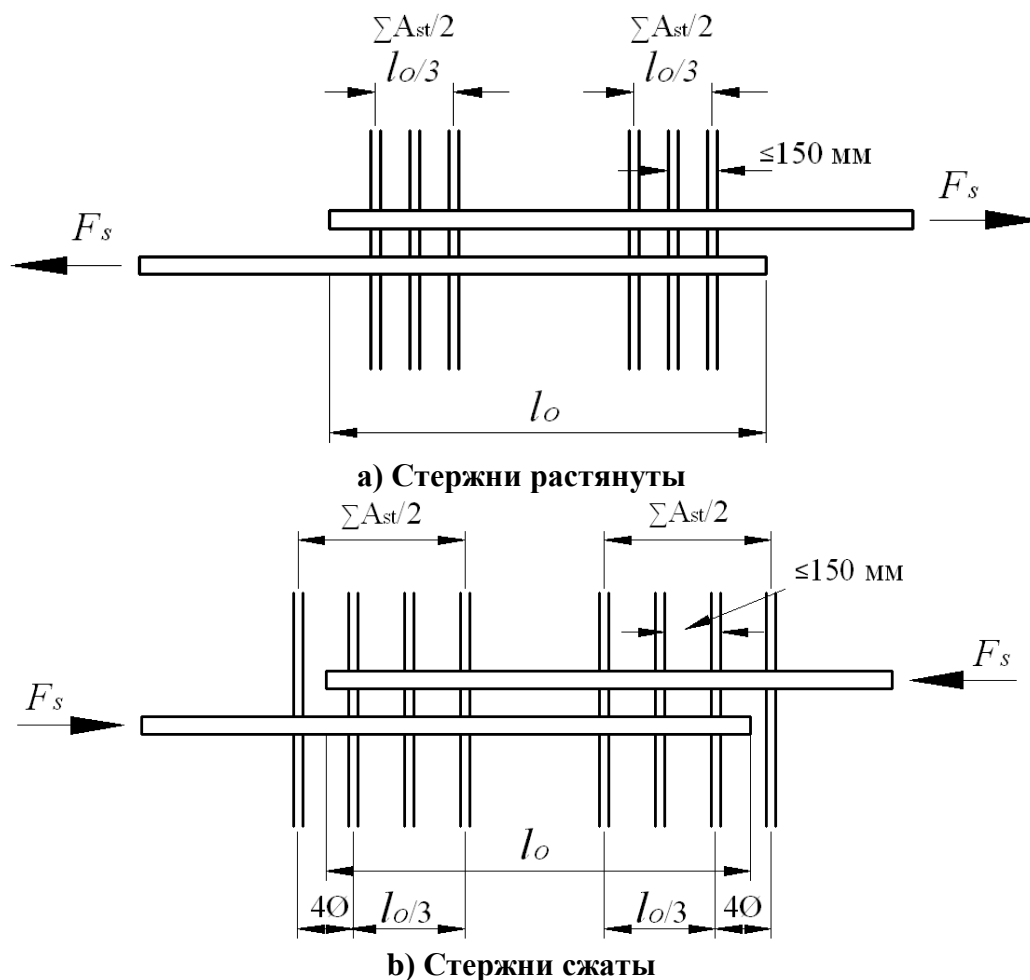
Поперечная арматура для соединений внахлестку
